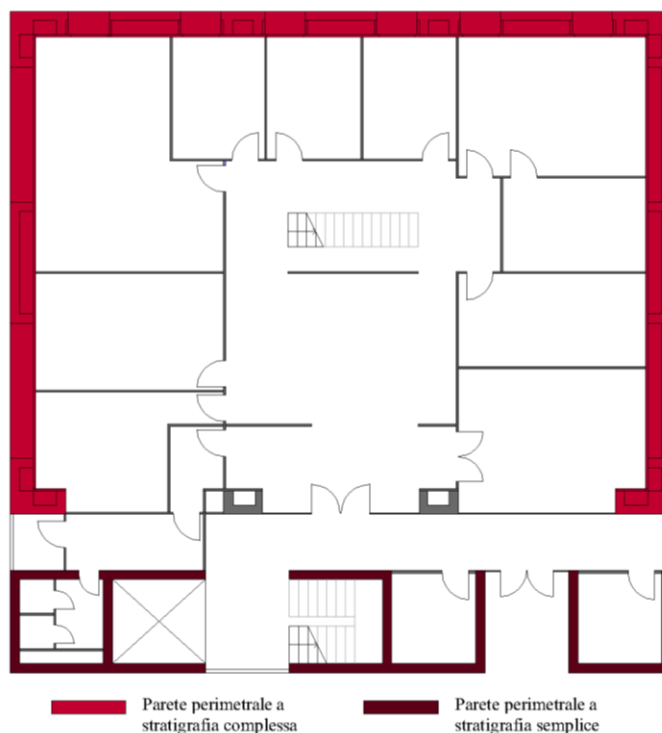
25 – Planimetria del terzo piano con individuazione tipologica degli elementi di chiusura verticale.
